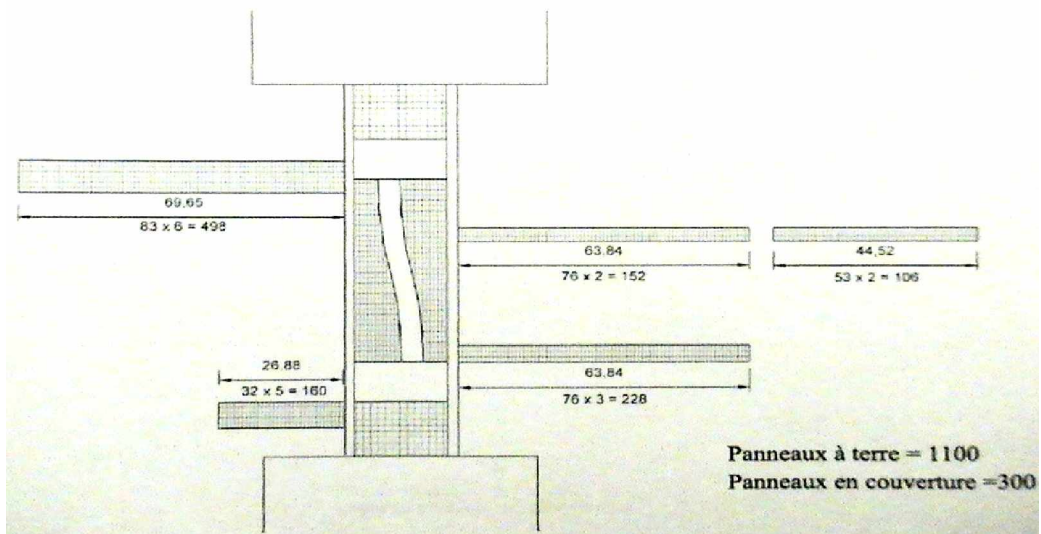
Plan de la couverture et panneaux solaires [Dossier Technique]
